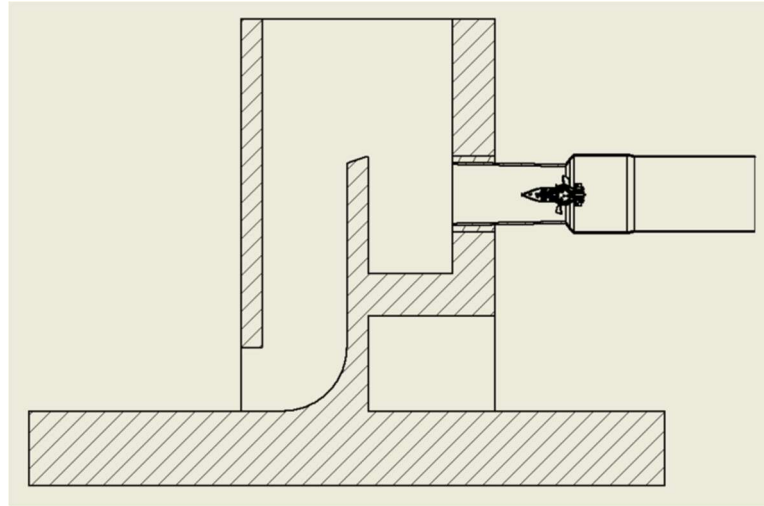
Desenho em corte de descarregador com turbina a montante
